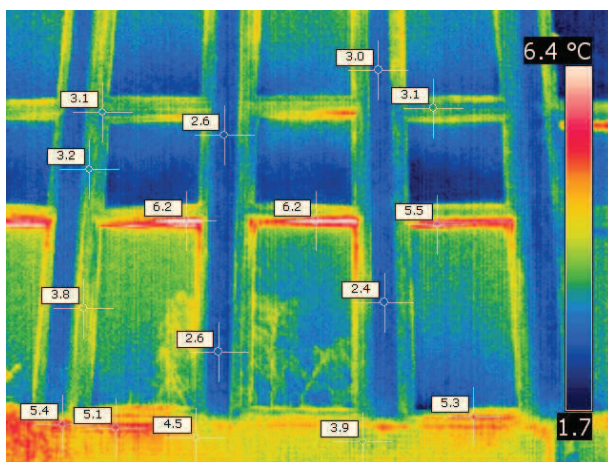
Окна помещений №213 и №211, западный фасад
